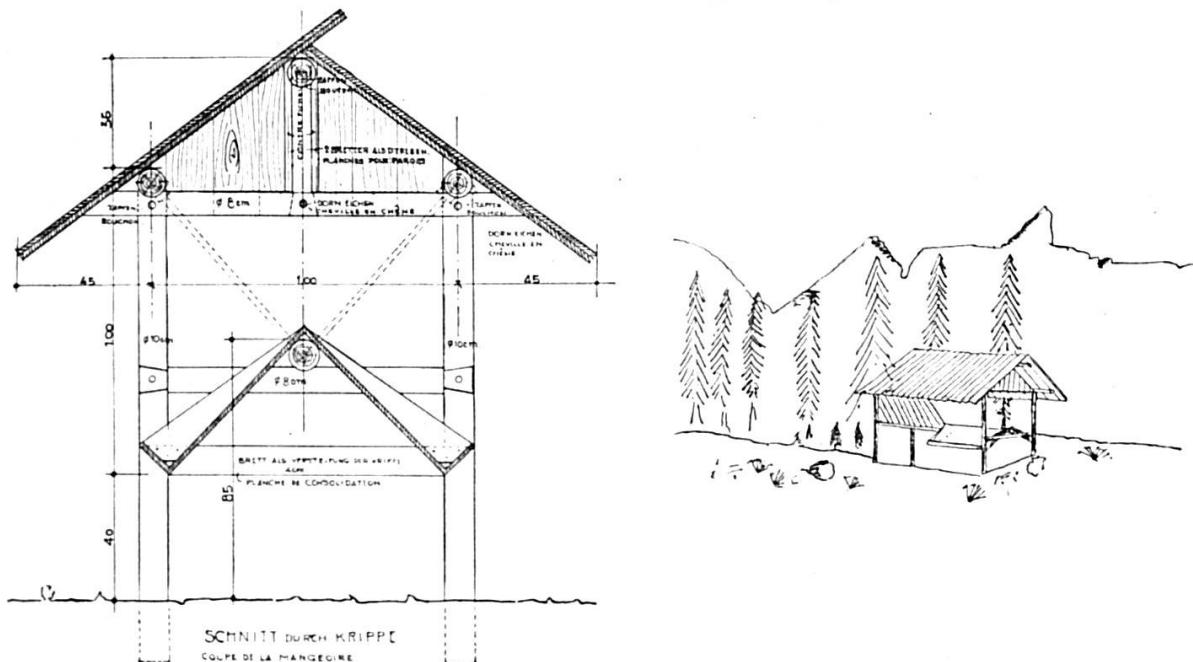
Plan I pour la construction d'une mangeoire pour chevreuils.
